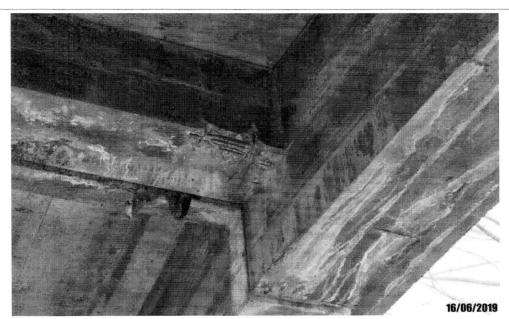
Detalhe de armadura exposta e eflorescência na face inferior do tabuleiro.
